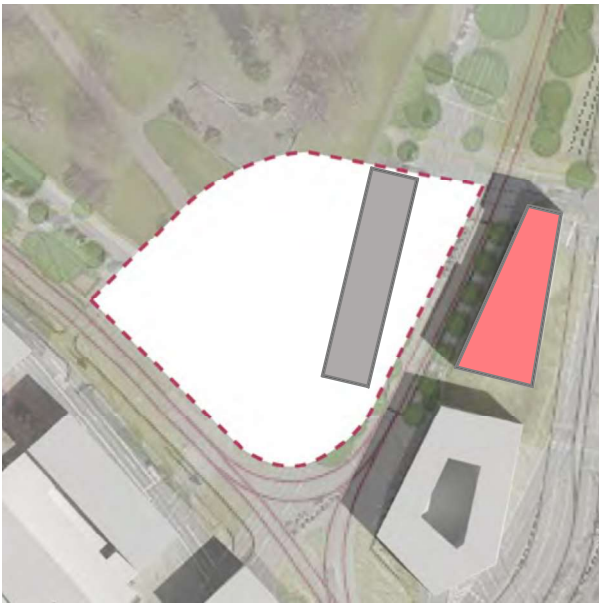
Grundriss UG Bahnhofsquartier V2
